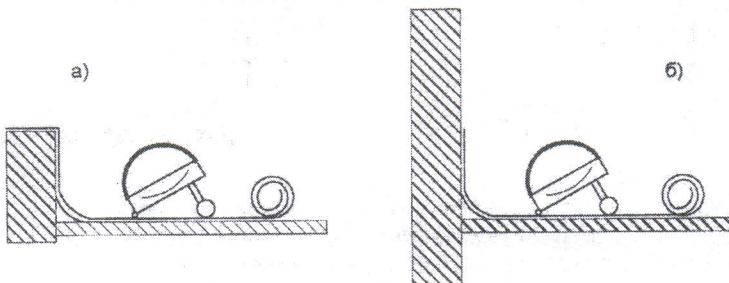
Примыкание кровли к вертикальным поверхностям:
